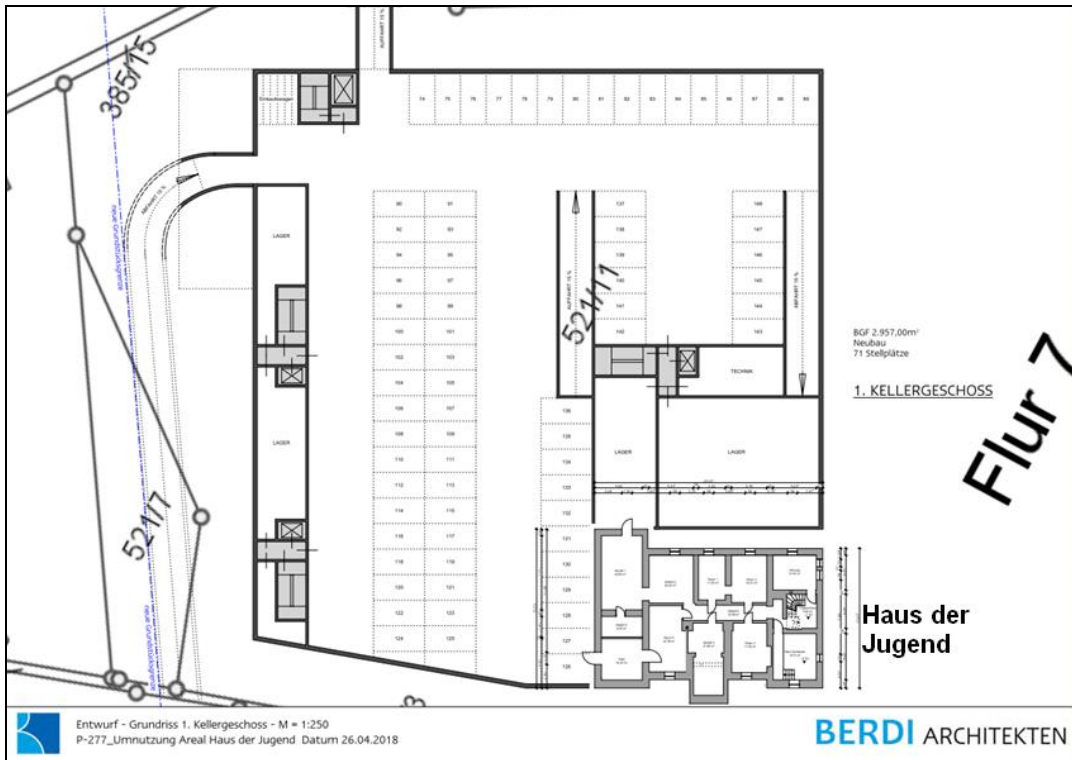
Grundriss 1. Kellergeschoss (Tiefgarage ca. 71 Stellplätzen + Technik-/Lagerräume) (Projektstand April 2018)
